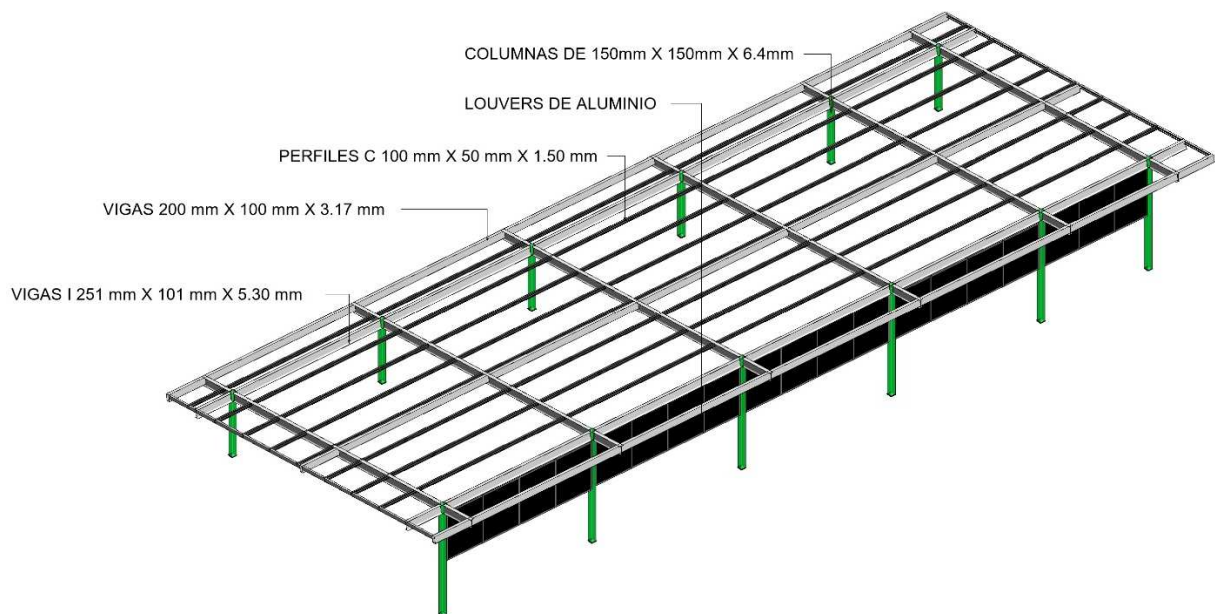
Esquema estructural cubierta en acero. Fuente: Elaborada por el autor.
